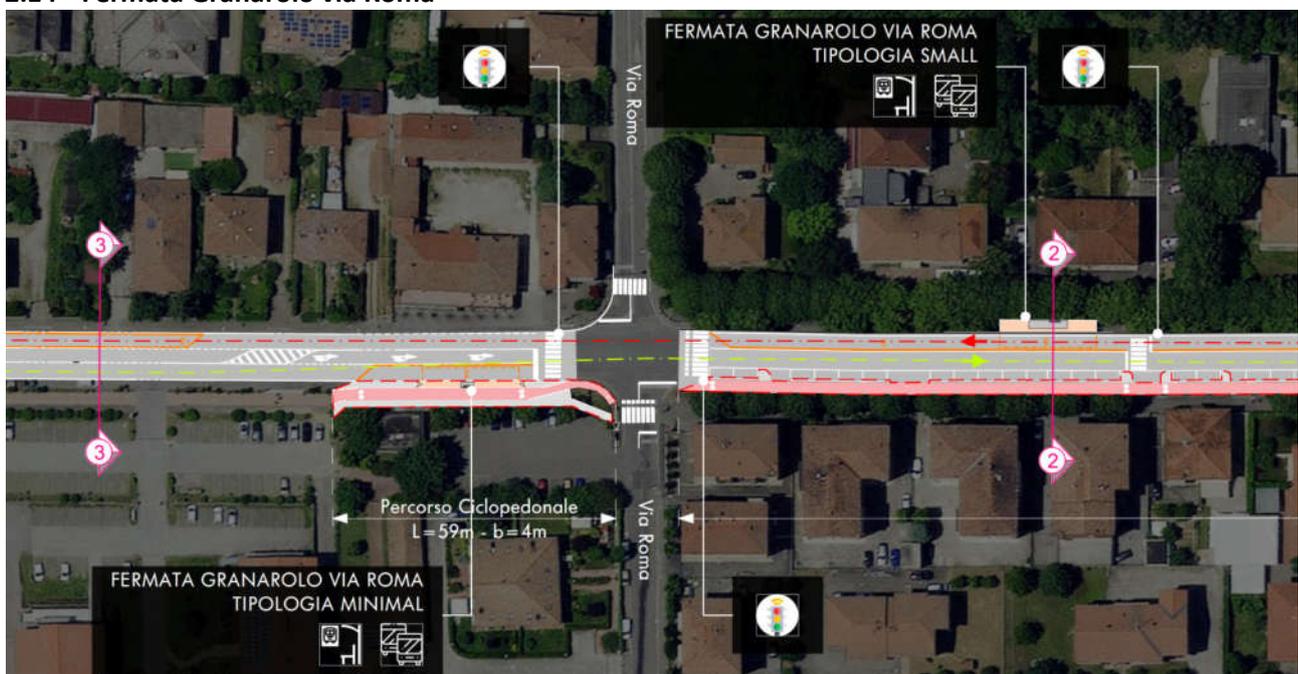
Fermata Granarolo via Roma - planimetria di progetto
